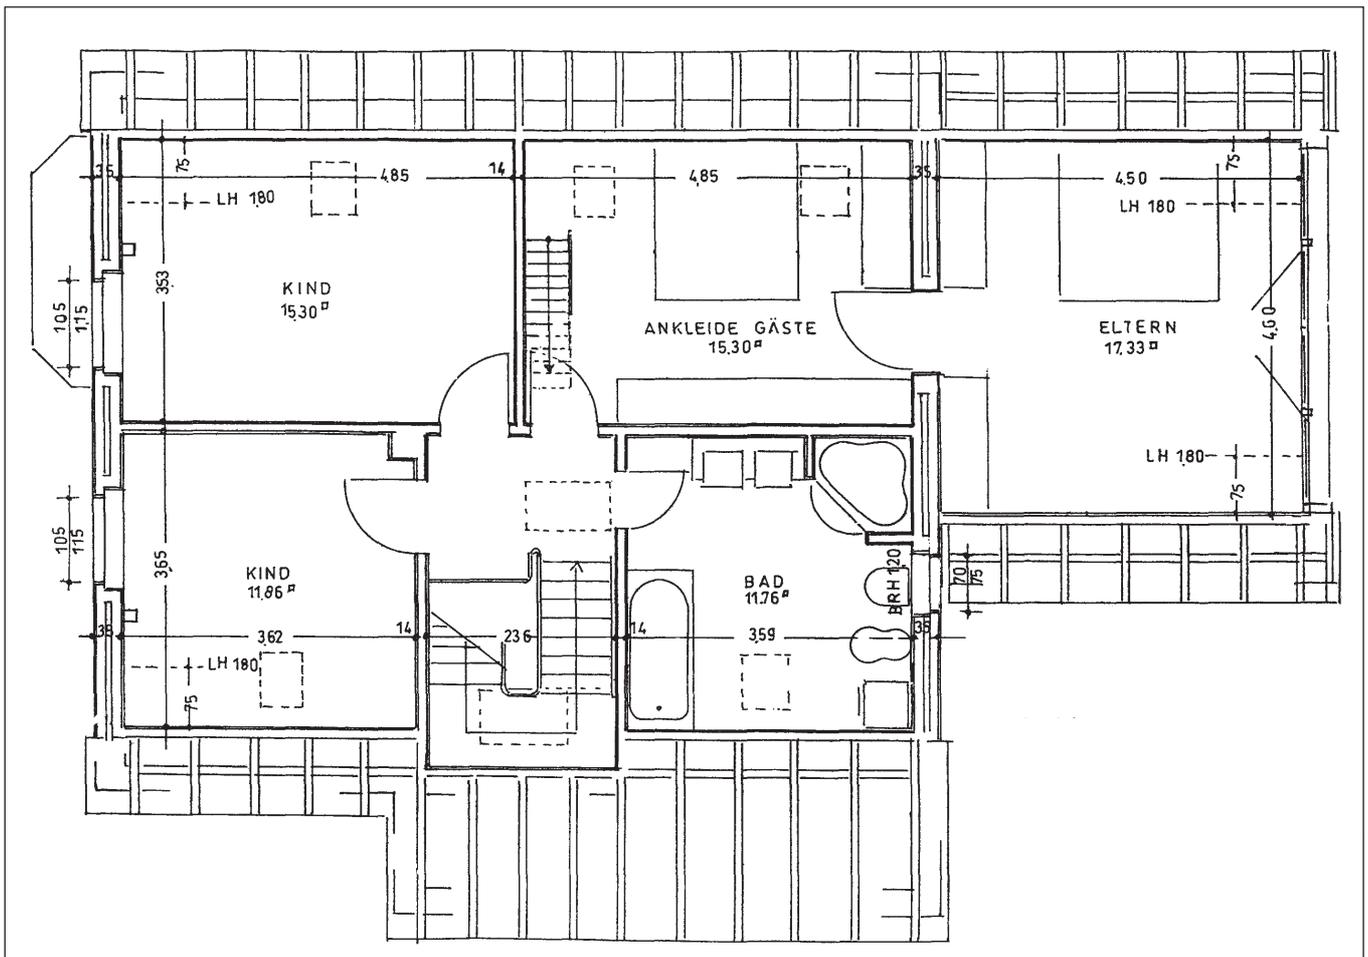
Beispielwohnung, Grundriss DG
